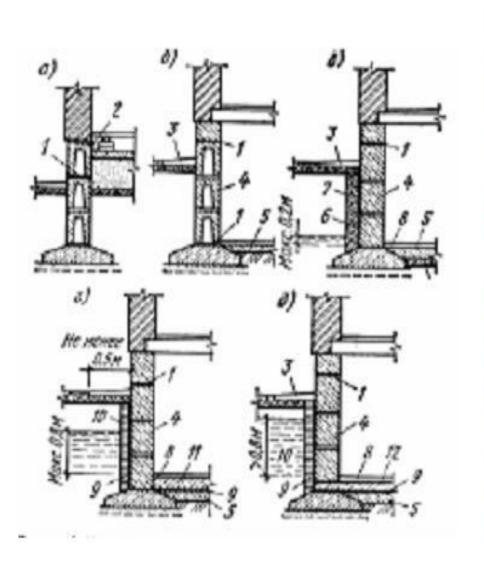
Изоляция здания от грунтовой влаги: а, б – гидроизоляция при отсутствии напора грунтовых вод
